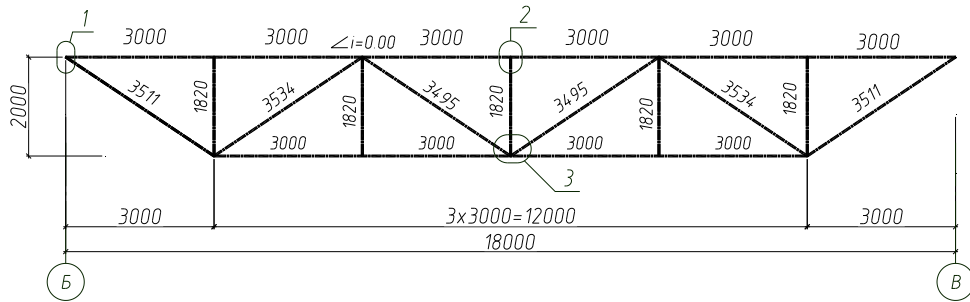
Схема к расчету и конструированию узлов фермы
